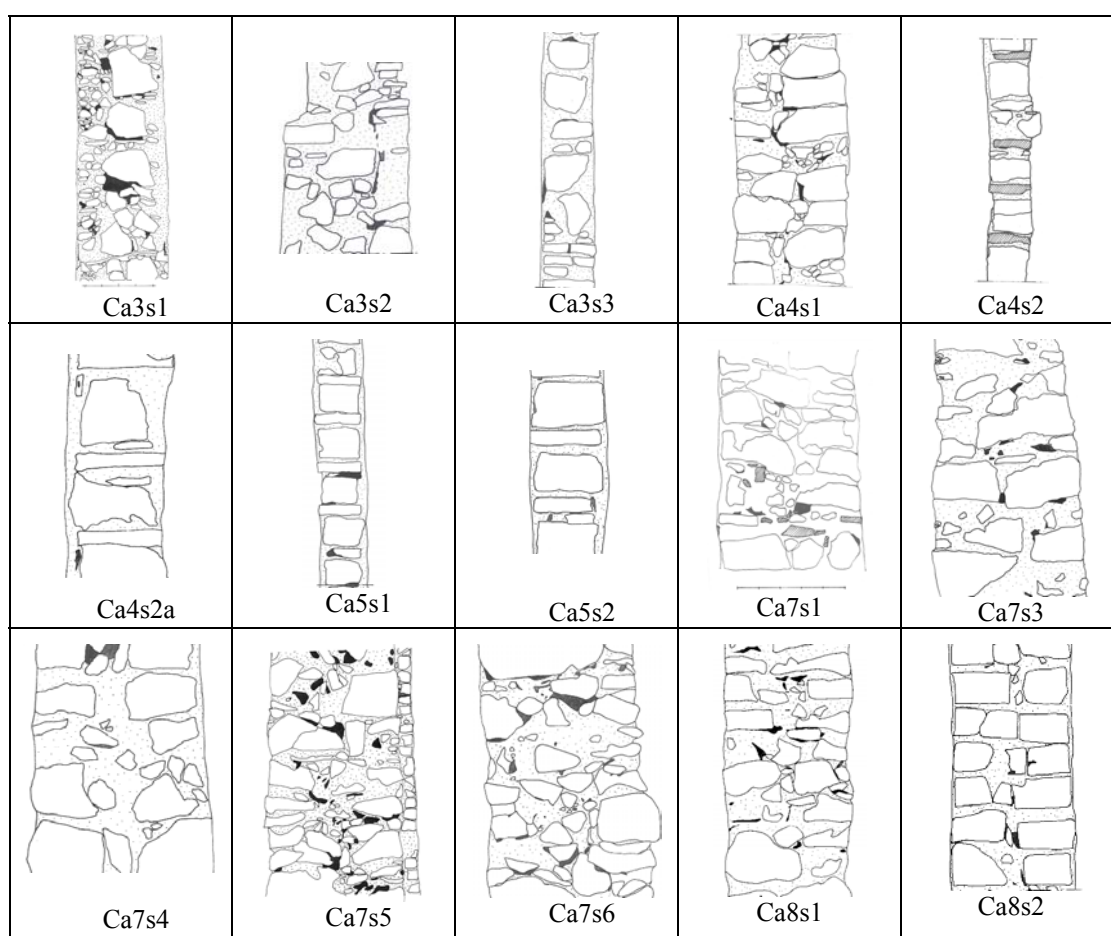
Sezioni murarie rilevate.
